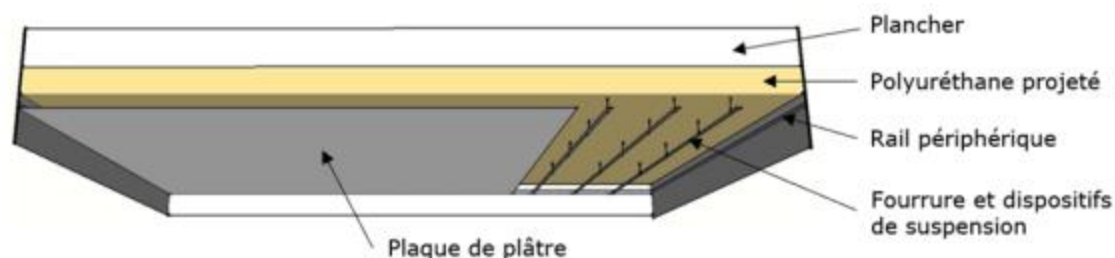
Plafond constitué de fourrures et de dispositifs de suspension
